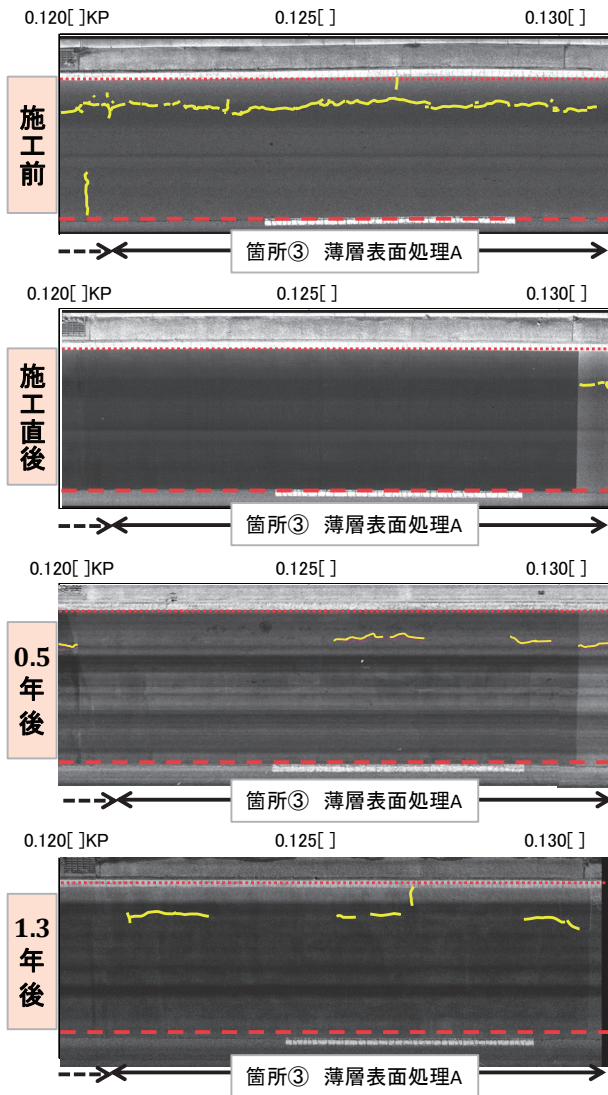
表面処理施工前後のひび割れ状況の変化(箇所③)
